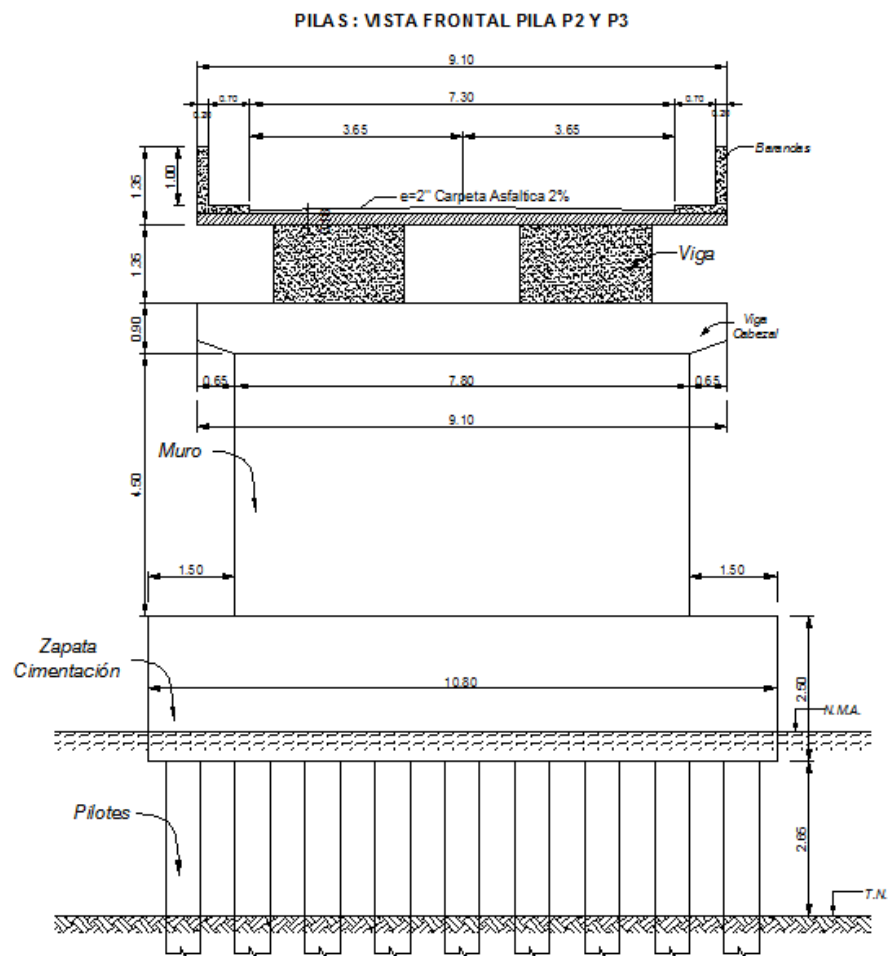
Vista frontal pilas P2 y P3 del puente de Tarifa.
